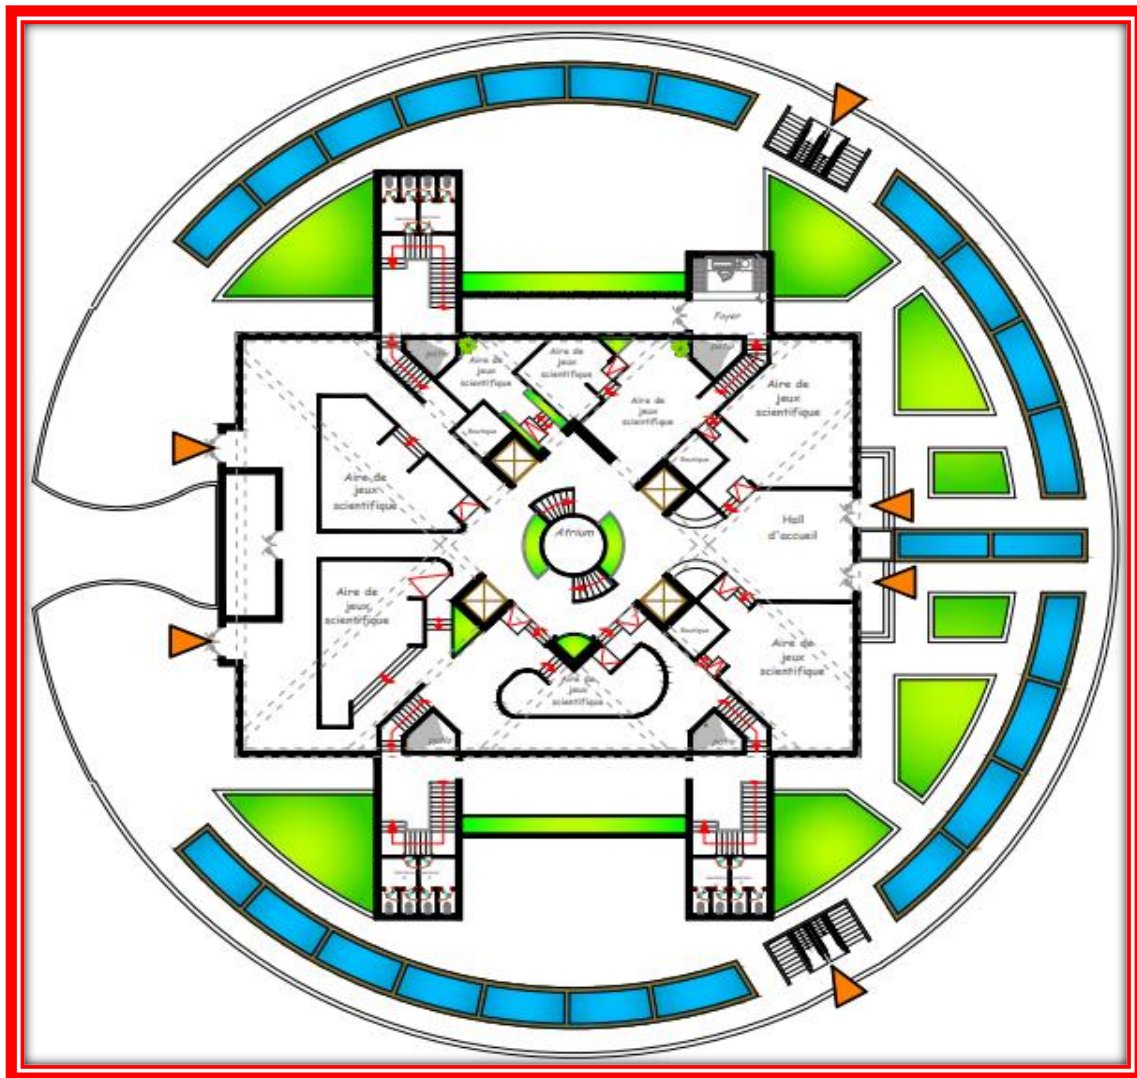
Le plan de niveau 1 (le casse-tête) / source : auteur
